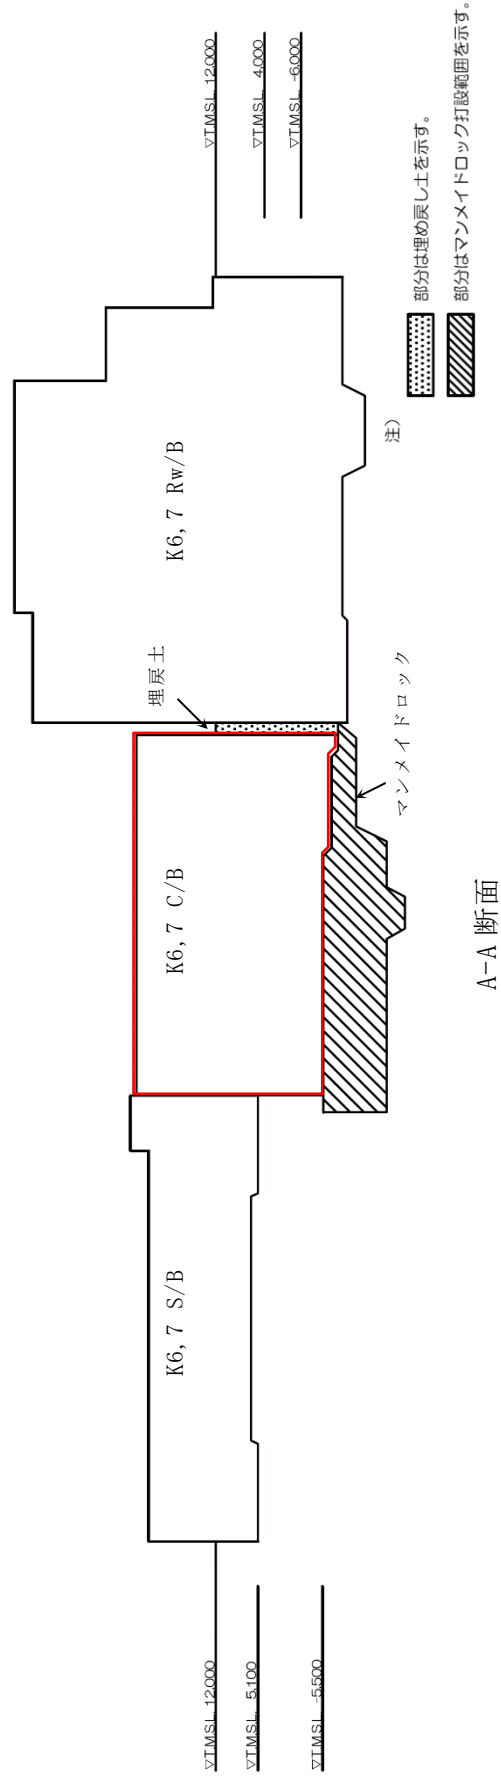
コントロール建屋の設置状況 (断面図) (単位 : mm)
